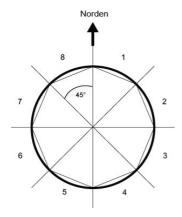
Aufteilung einer Rundfassade in 8 Fassaden
